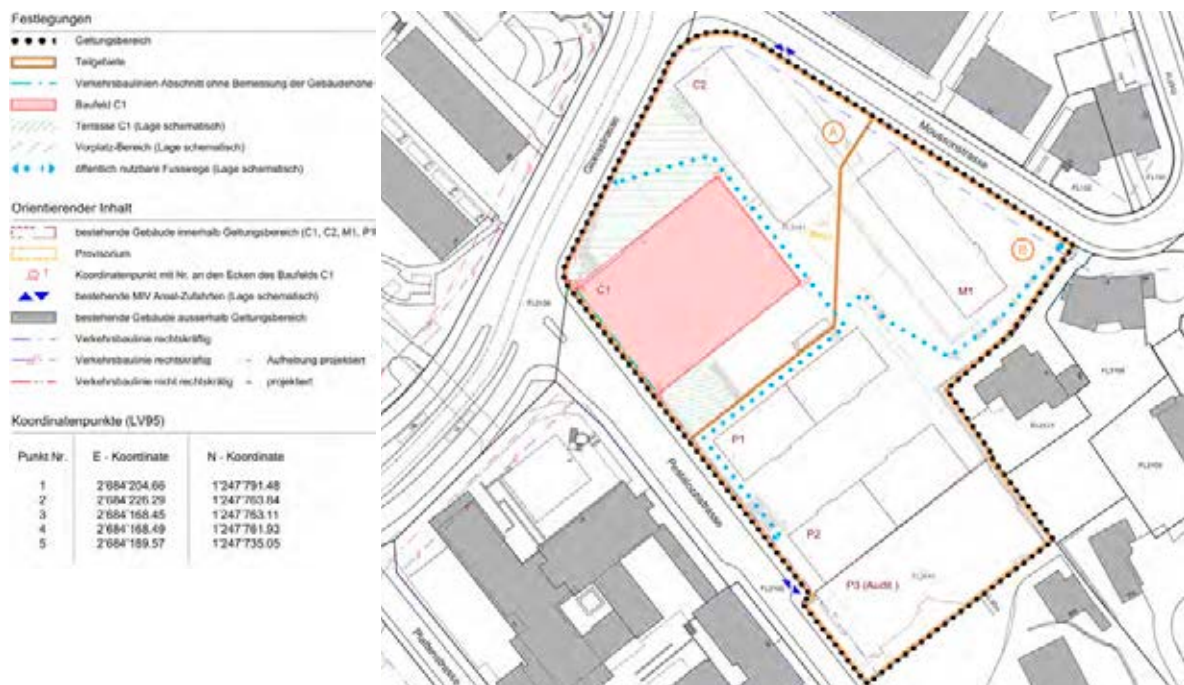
Auszug des Plans zum Gestaltungsplan (beiliegend)
